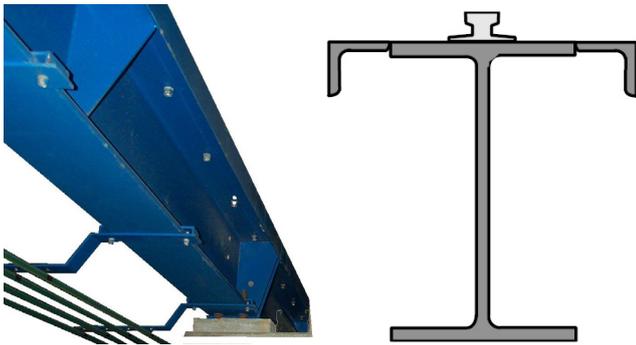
Mit Winkeln verstärkte Walzprofile (links mit kerbgünstig angeklebten Anbauteilen).
